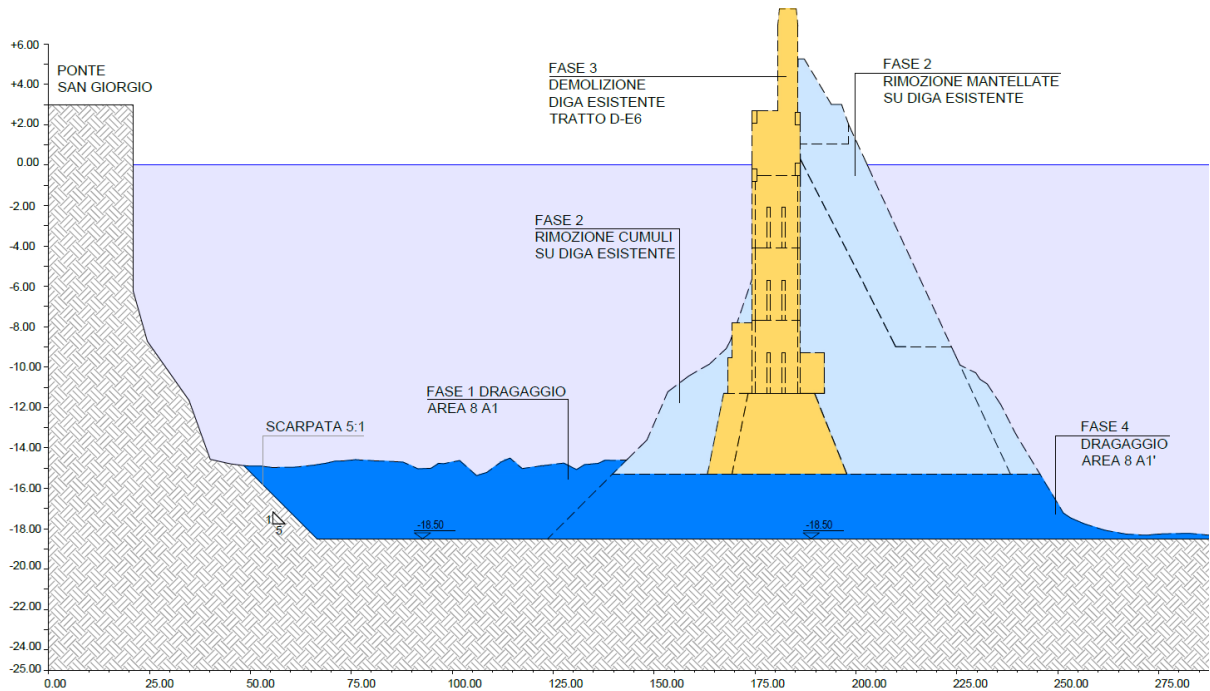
Sezione tipologica di progetto del dragaggio a -18.50 m slmm.
